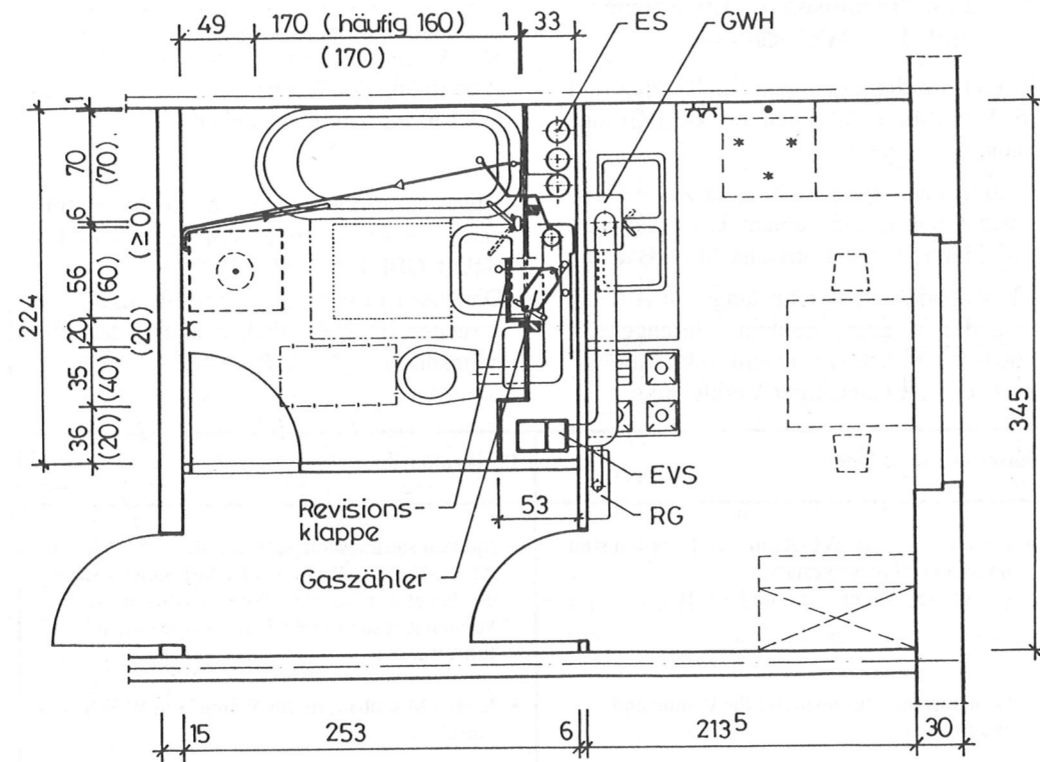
Grundriß Außenküche/Innenbad - Potsdam, Lennéstr. 3-5, Baujahr 1986
